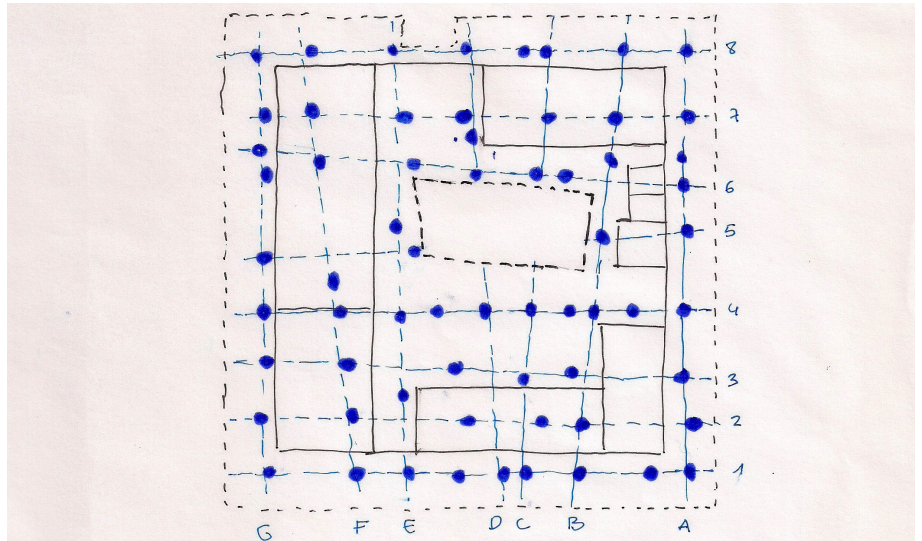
Dibujo análisis planta de estructura. Elaboración propia
